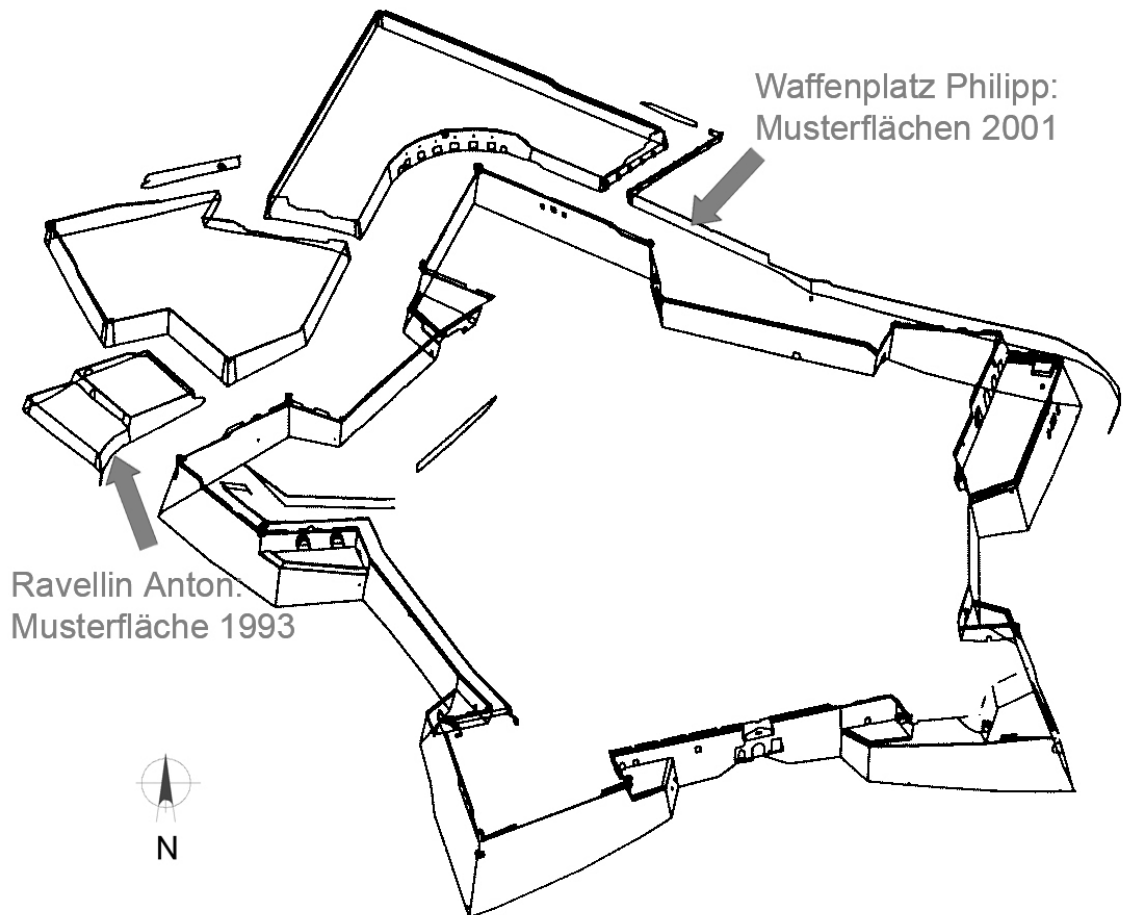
Kronach, Festung Rosenberg. Planzeichnung 2009 (Staatliches Bauamt Coburg) mit Angabe der Musterflächen an den Wallmauern
